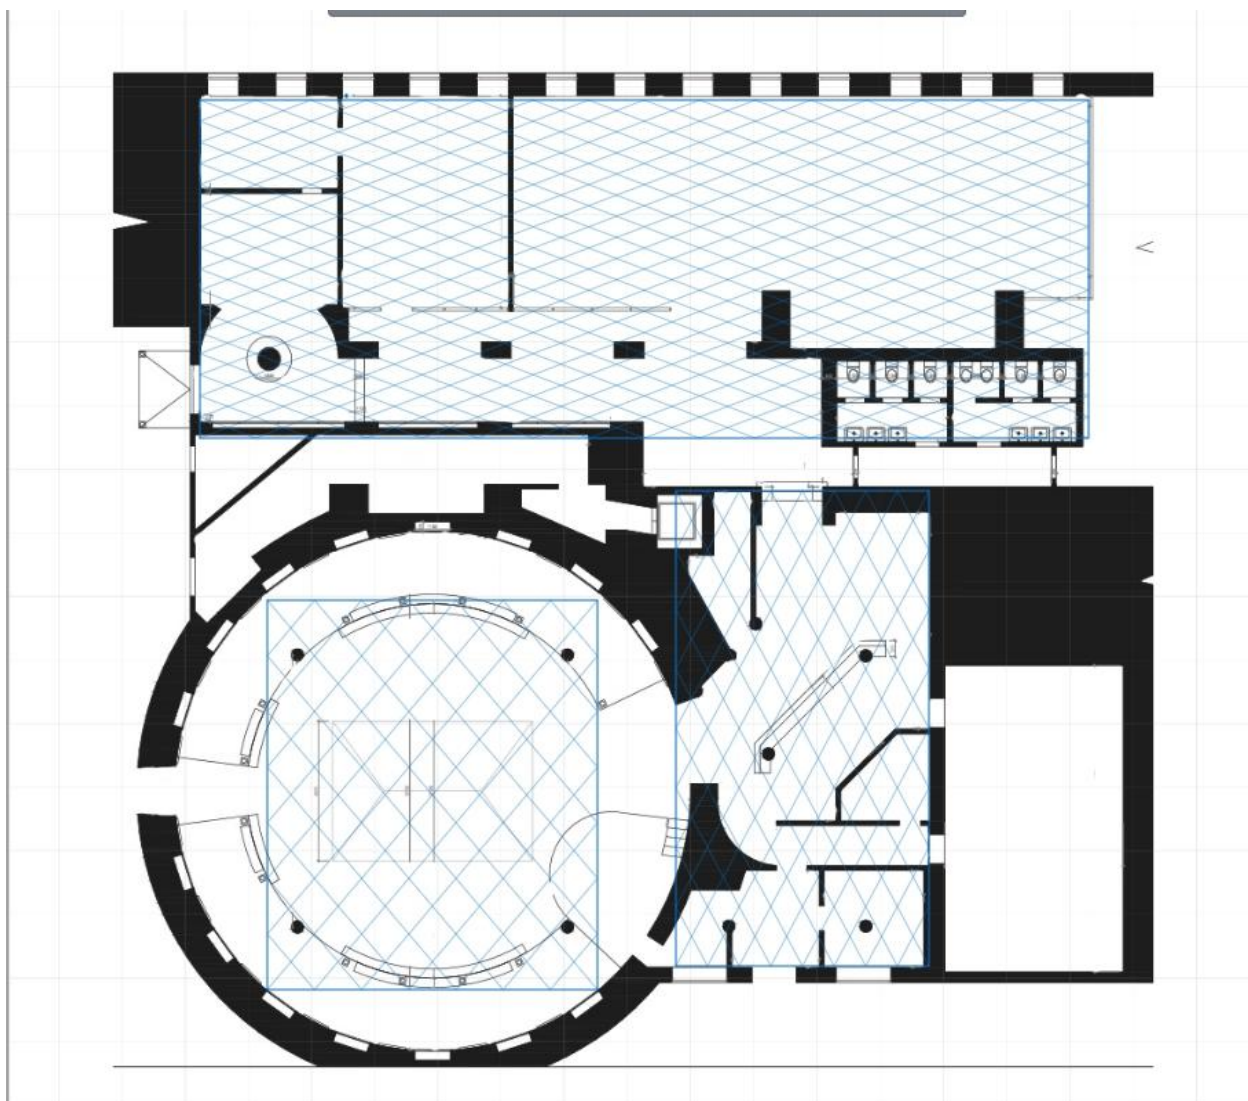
Нанесение на схему зон покрытия wi-fi.
